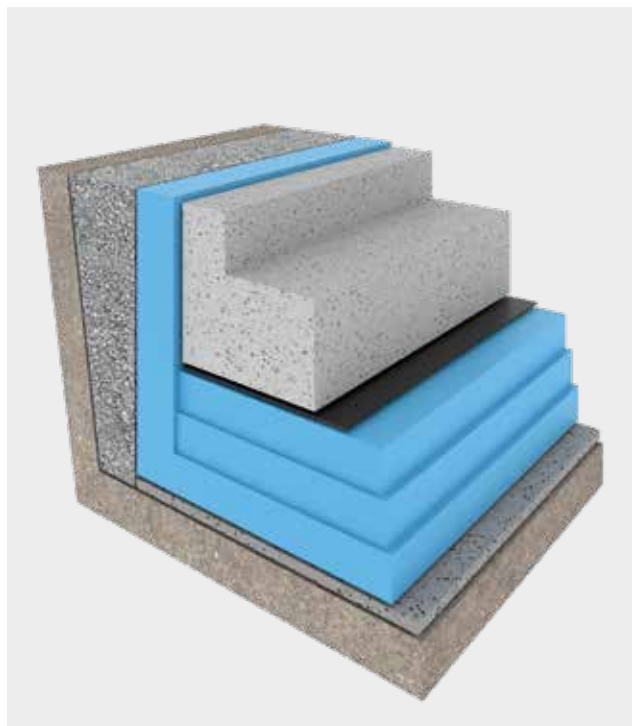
Detailbeispiel Fußpunkt „Weiße Wanne“: Wärmedämmung an Wand und unter lastabtragender Gründungsplatte in drückendem Wasser
